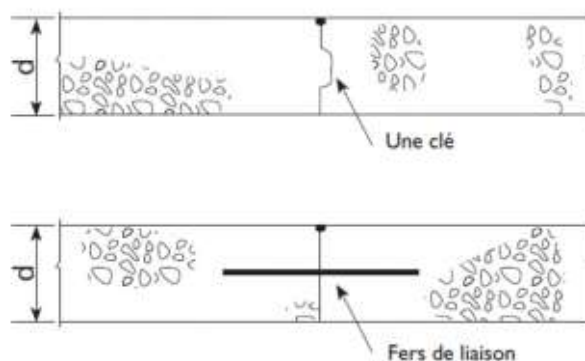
Schéma de joints longitudinaux de construction (source CimBéton).
